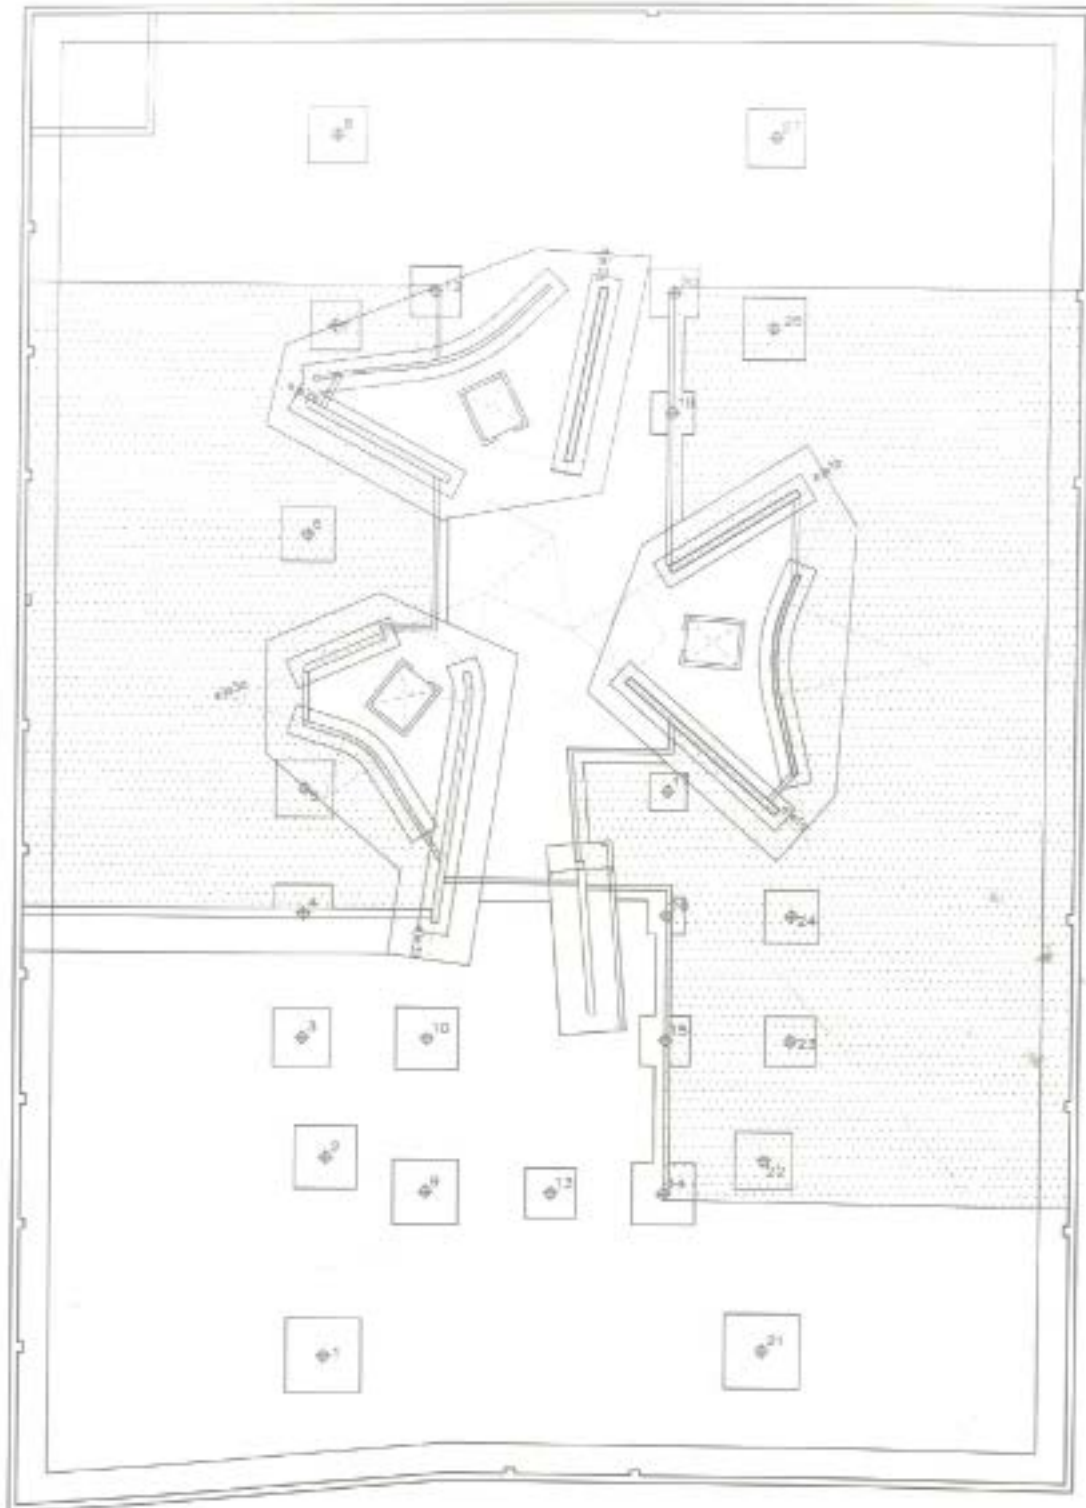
Planta de la cimentación de la Torre Cube (izquierda). Documentos de Arquitectura nº 60. Revista del Colegio de Arquitectos de Almería.
